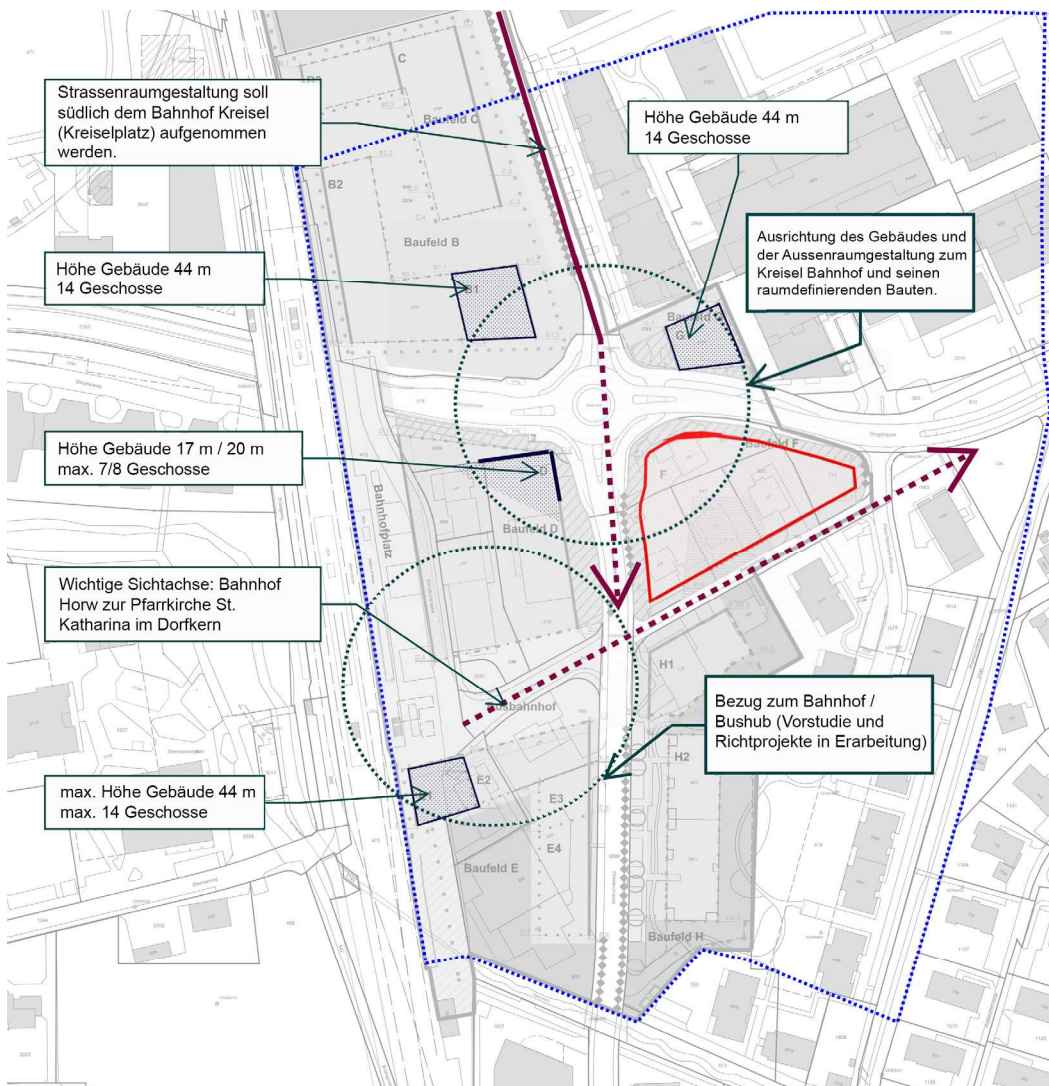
Betrachtungsperimeter (blau) und Areal (rot) mit wichtigen Bezügen
